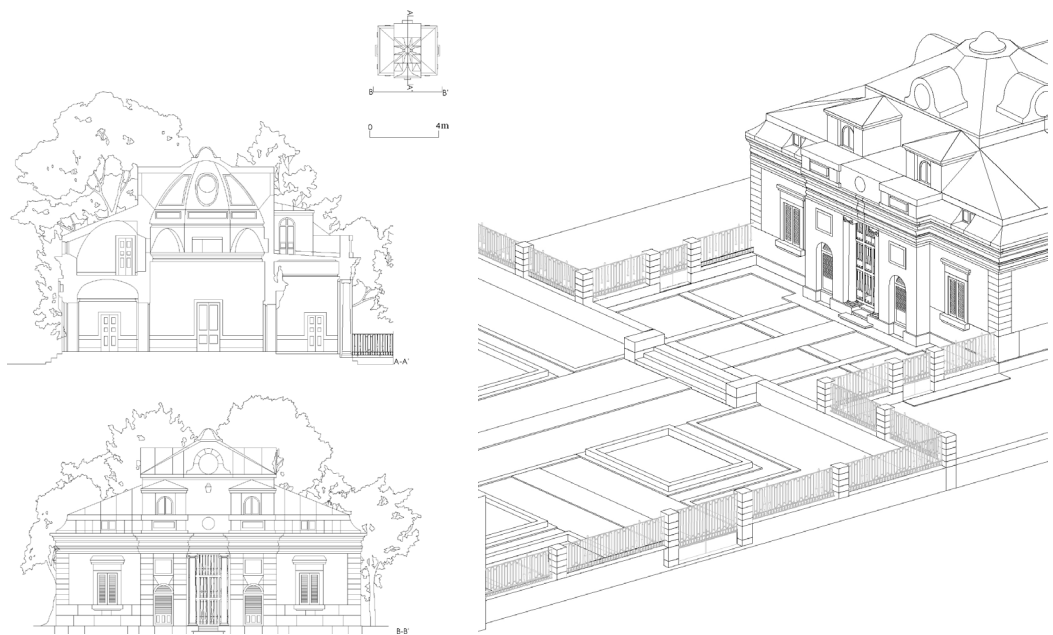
La Casita de Arriba, sezione longitudinale (in alto), prospetto Nord (in basso). Elaborazione grafica degli autori.
